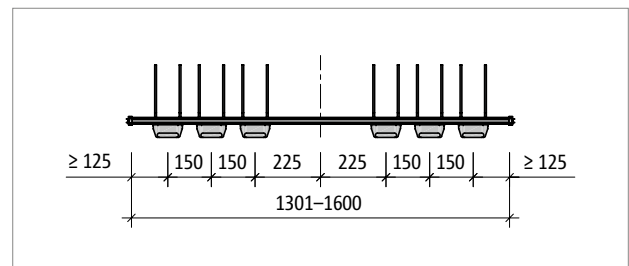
Schöck Tronsole® Typ T-V6...-L1301 bis L1600: Produktgrundriss
